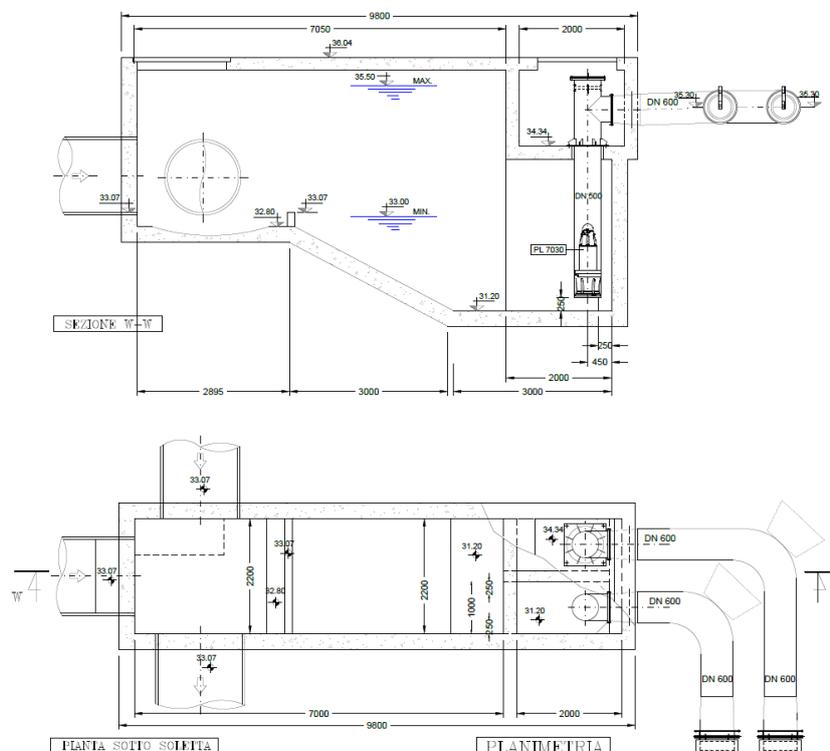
| Vista in sezione e pianta dell'impianto di sollevamento S1.
